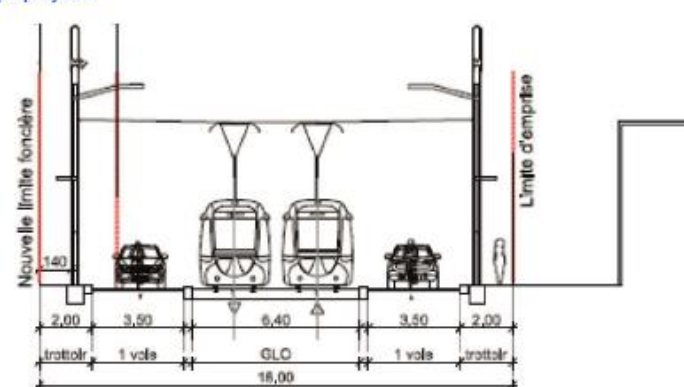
Phasage de principe sur l'avenue de Gambetta
